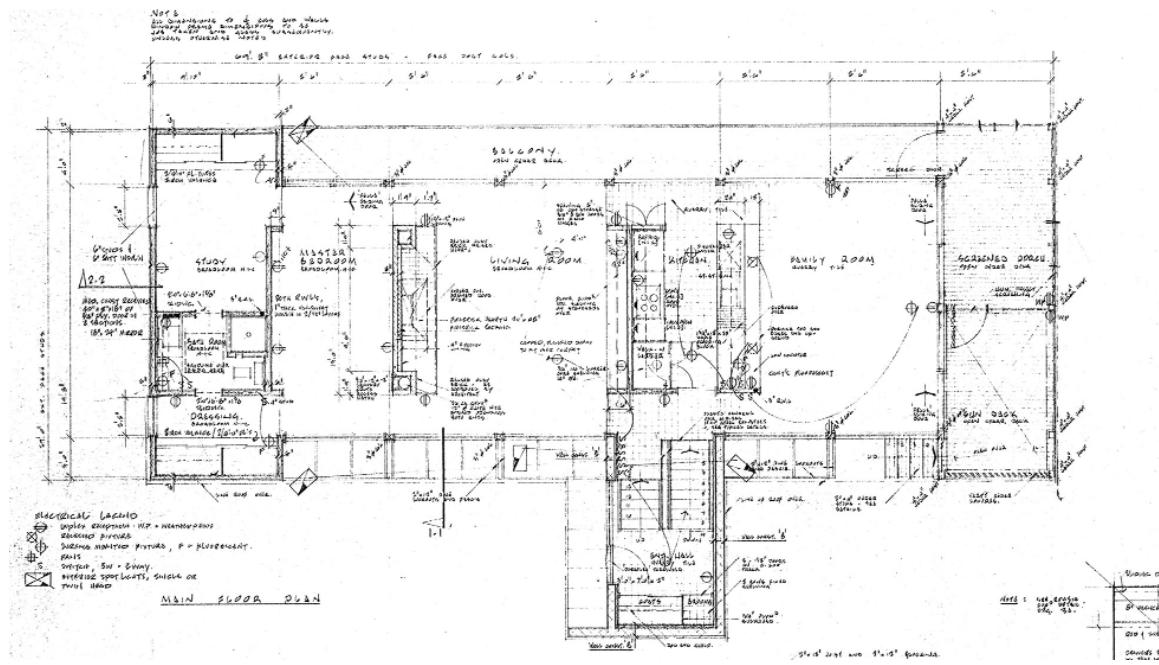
Maison Butler (1962), Brian Barkham architecte, plan du rez-de-chaussée (avec la permission de la famille Butler)
